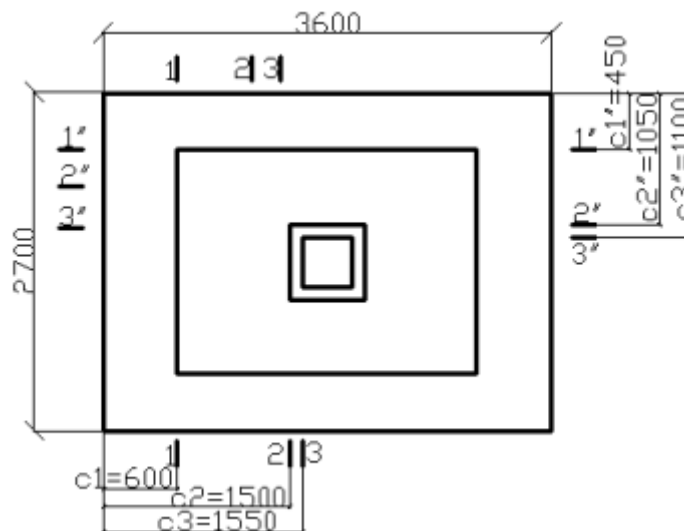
Схема до розрахунку армування плитної частини фундаменту
